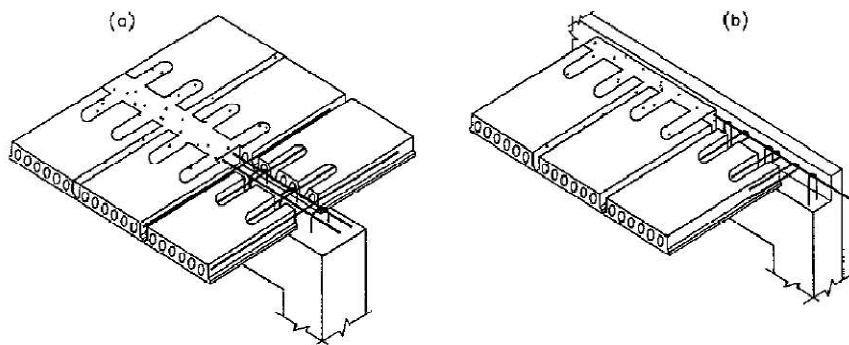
Ligação de lajes alveolares: (a) viga rectangular; (b) viga com abas laterais (adaptada de [46])
